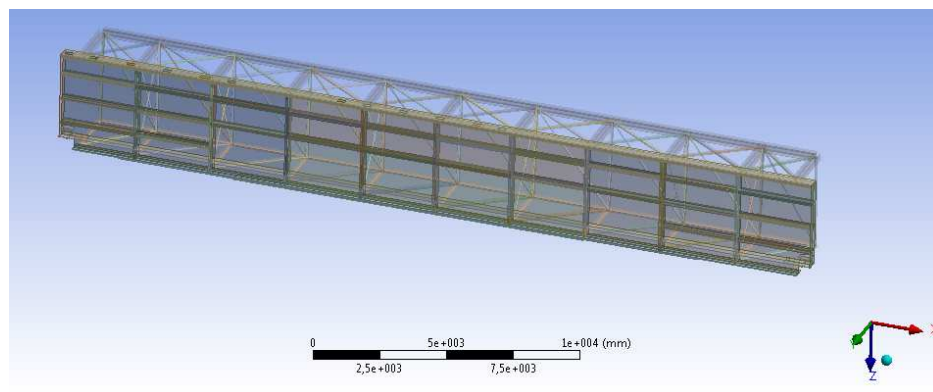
Modelo 3D da viga de rolamento de 30 metros formada por elementos de casca e viga
